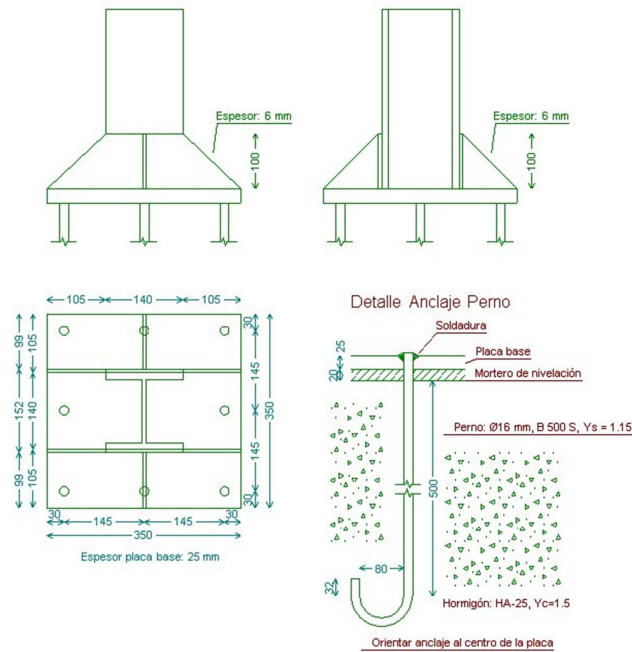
Detalle de las placas de anclaje de los pilares extremos de pórticos de fachada
